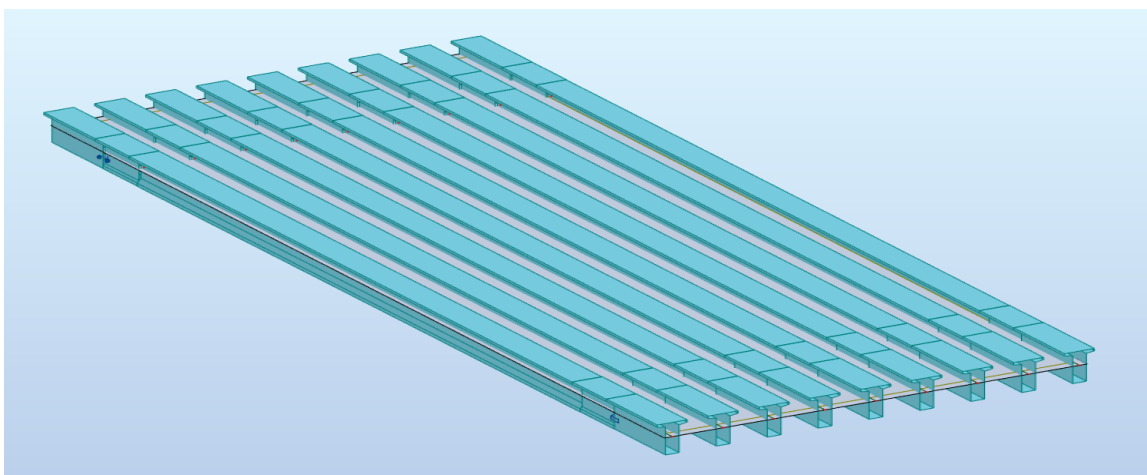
Définition des poutres, dalle, entretoise, appui.
